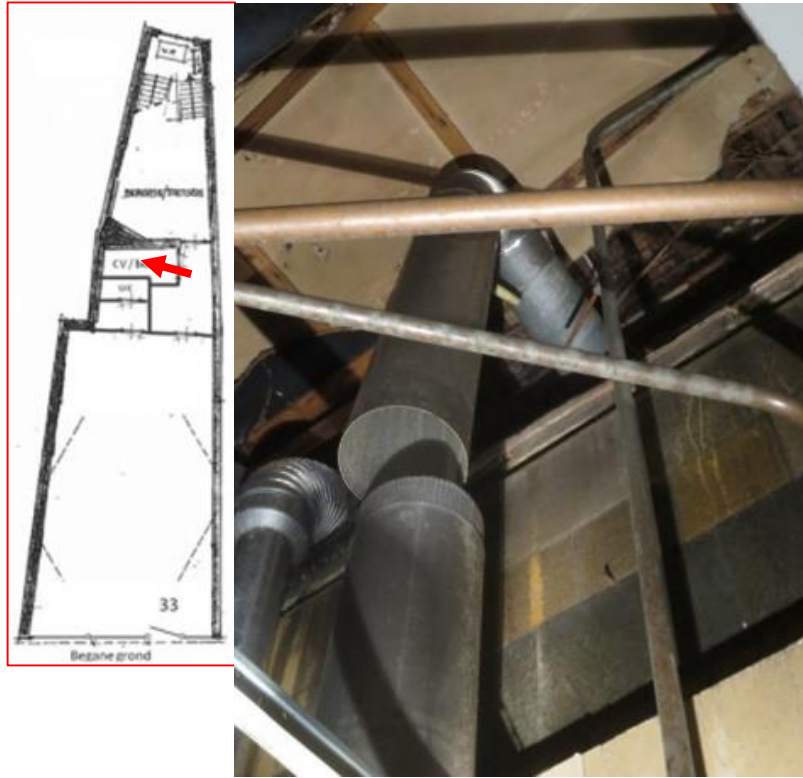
, toevoerkanaal boven plafond opstelruimte CV en boiler. (foto gemeente Leeuwarden).
